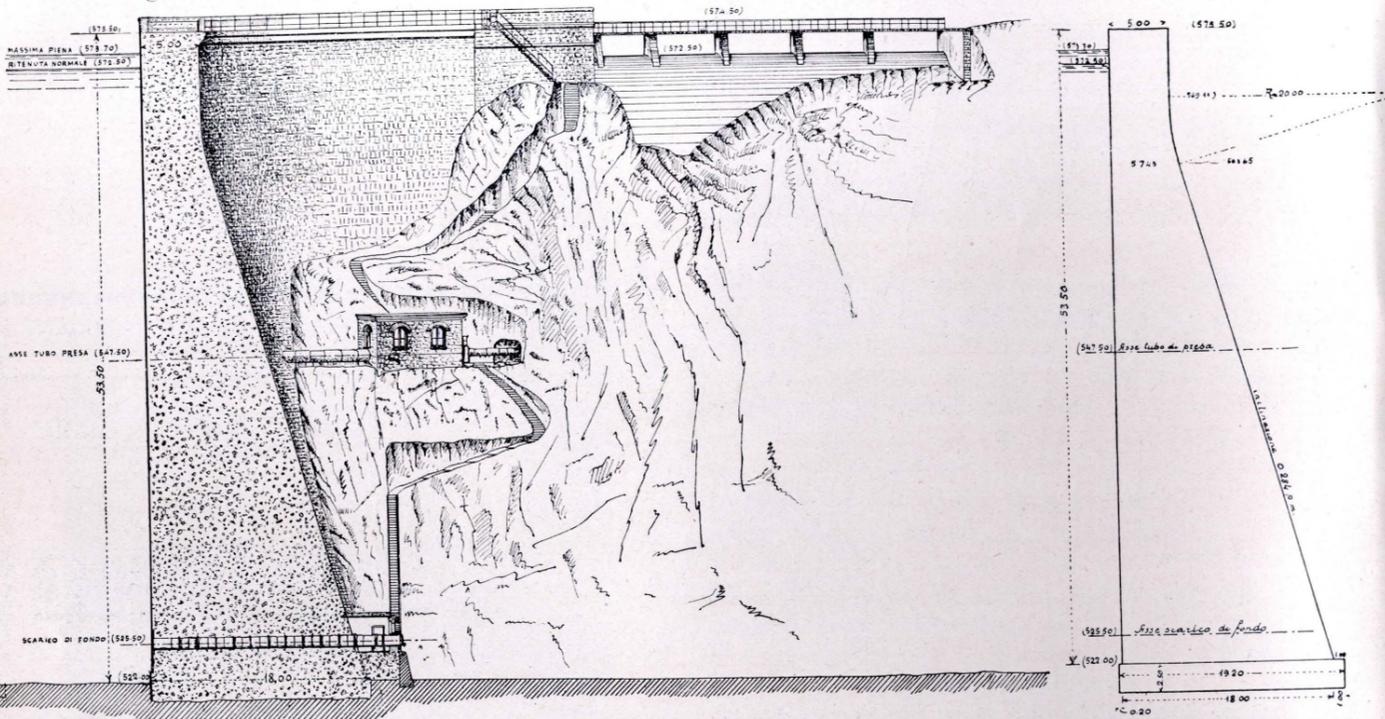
Sezione trasversale della diga e prospetto dello sfioratore. (Scala 1:600).
